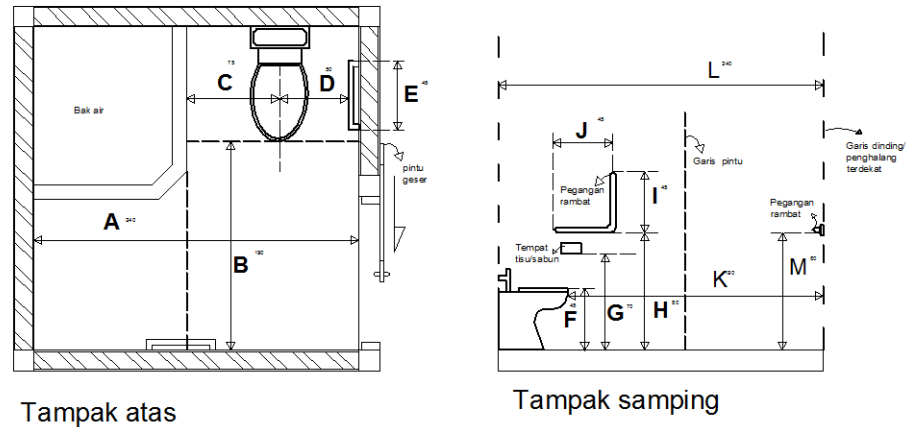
Gambar LXX: Denah Sirkulasi dan potongan ruang ruang toilet
